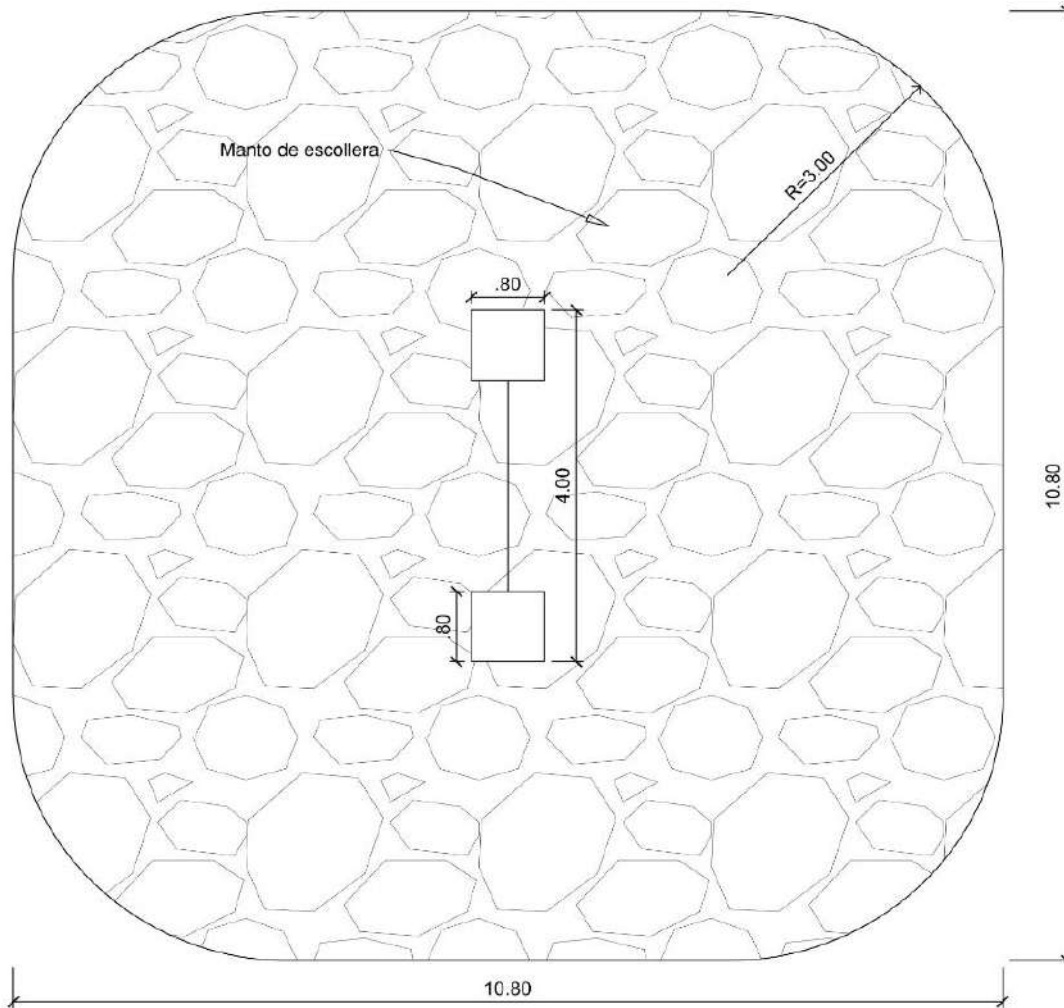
Diseño propio de manto de escollera para pilares 3, 4, 5, 6 y 7, vista en planta
